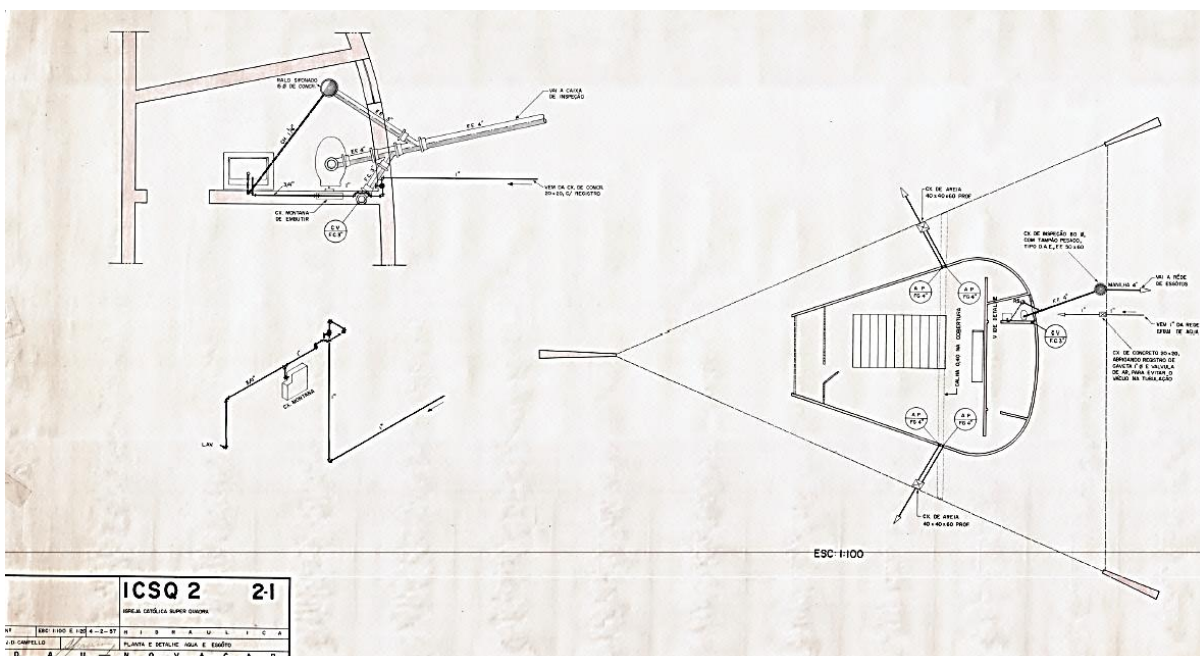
| Projeto construído. Planta hidráulica. 4.2.1957
